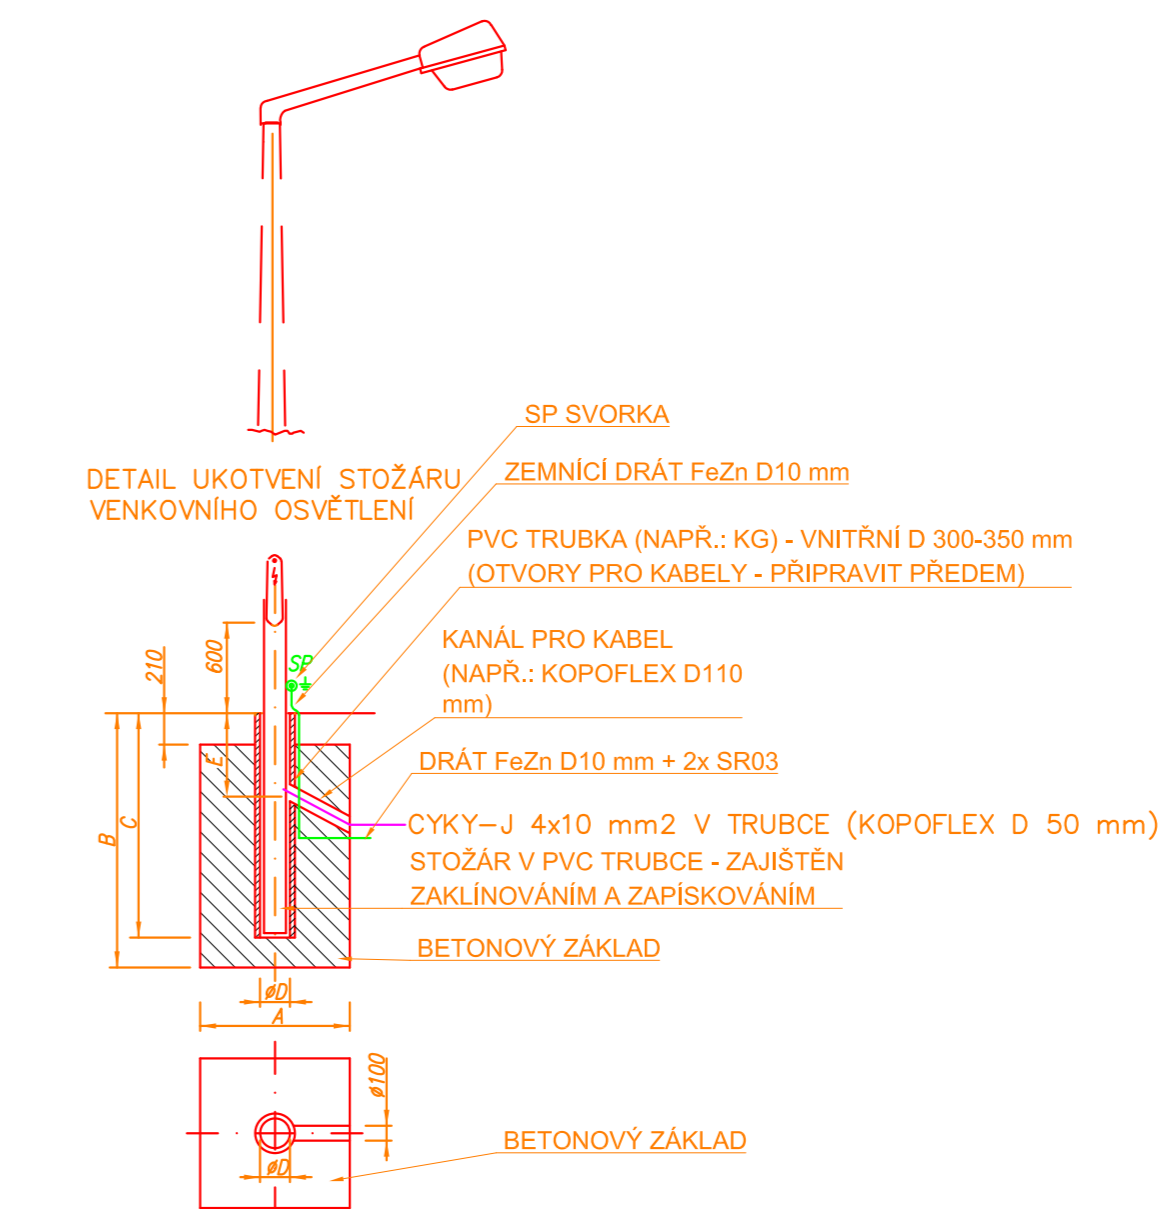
DETAIL ULOŽENÍ STOŽÁRU (POUZDROVÝ ZÁKLAD):
